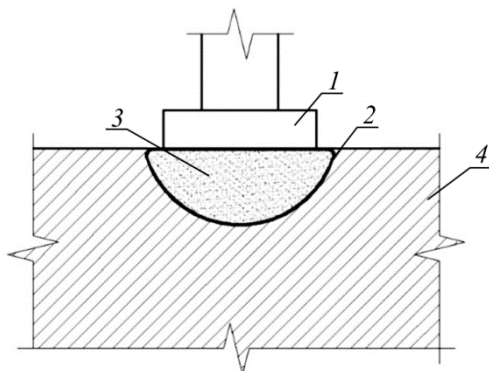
Подготовка под фундамент с песчаной подушкой, армированной по контуру геосинтетическим материалом: 1 – ленточный фундамент; 2 – армирующий геосинтетический материал; 3 – песчаная подушка; 4 – грунт основания
